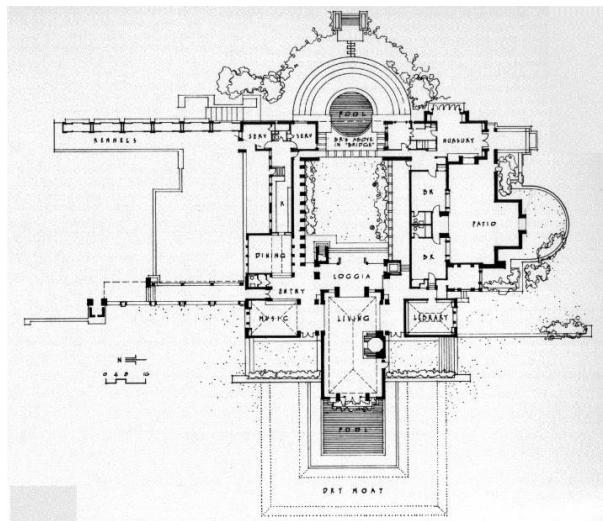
План 1-го поверху житлового будинку “Рожа”, арх. Френк Ллойд Райт
